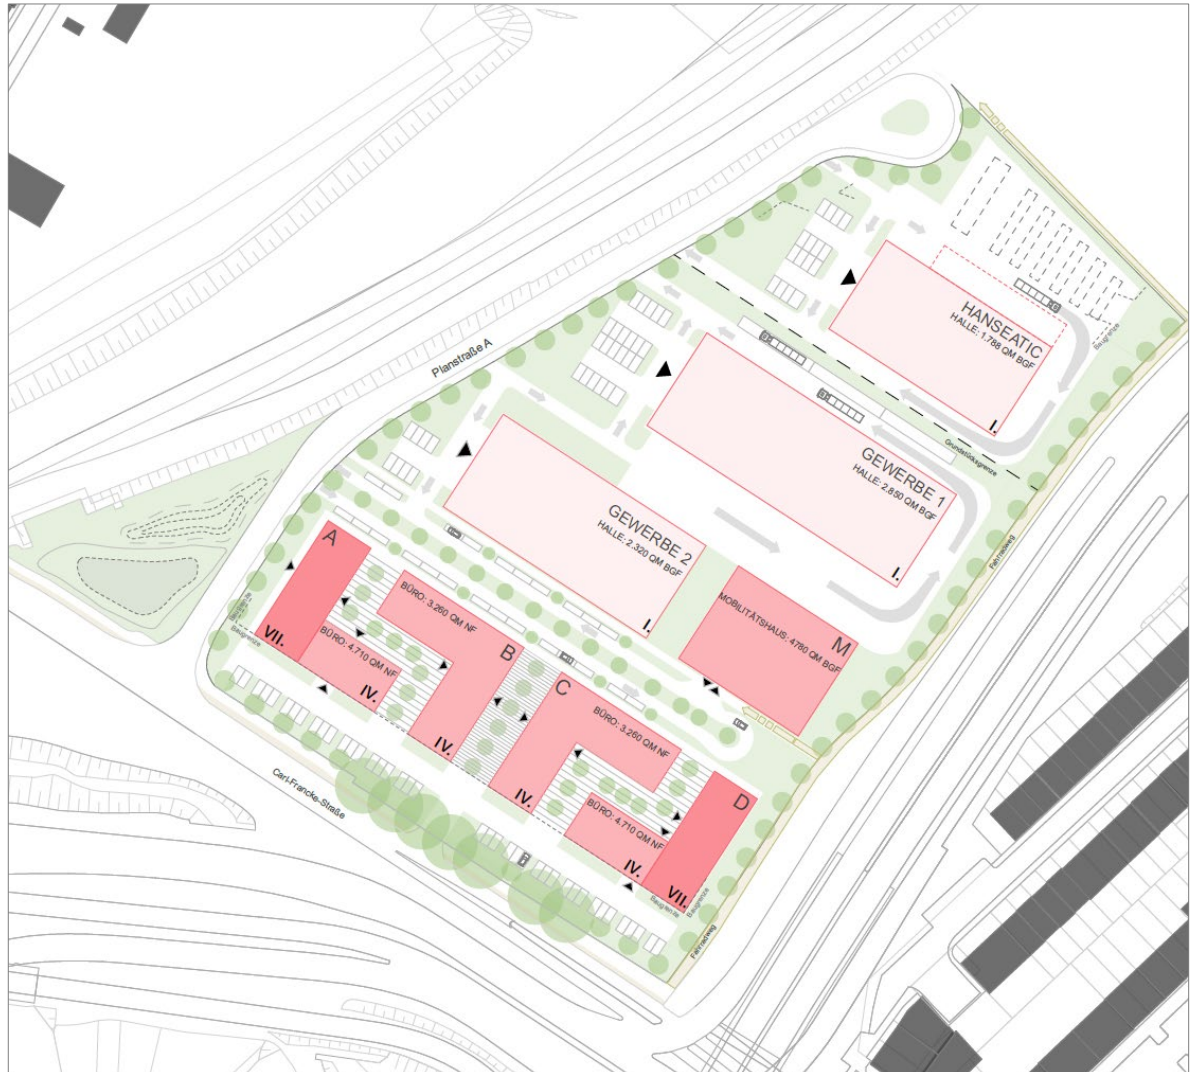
Städtebauliche Konzeption Plangebiet Bebauungsplan 2284 (informativ; Quelle: Westphal Architekten BDA)
